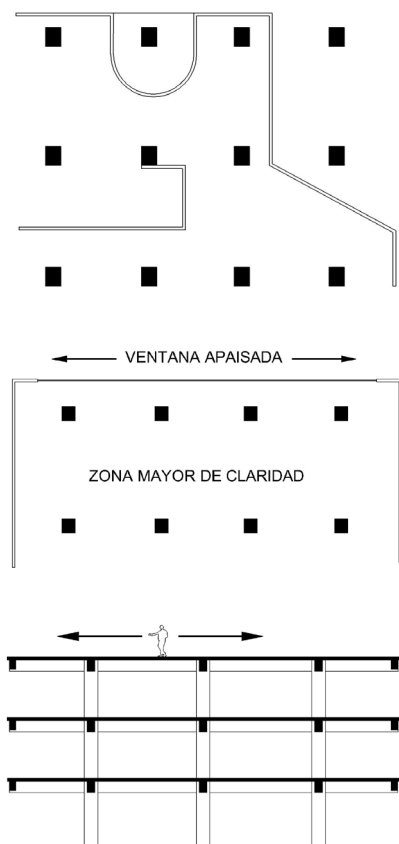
Las divisiones o pieles no son estructurales, y pueden ser muy totalmente transparentes. La terraza se puede utilizar.
